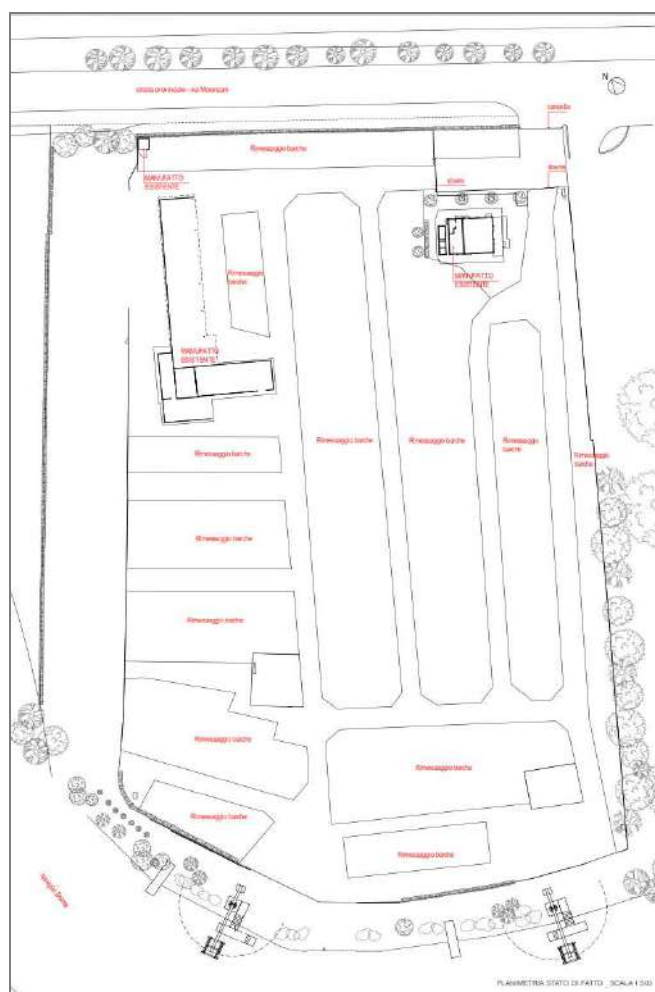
Pianta dell'area allo stato attuale della ditta Centro Nautico Fusina
